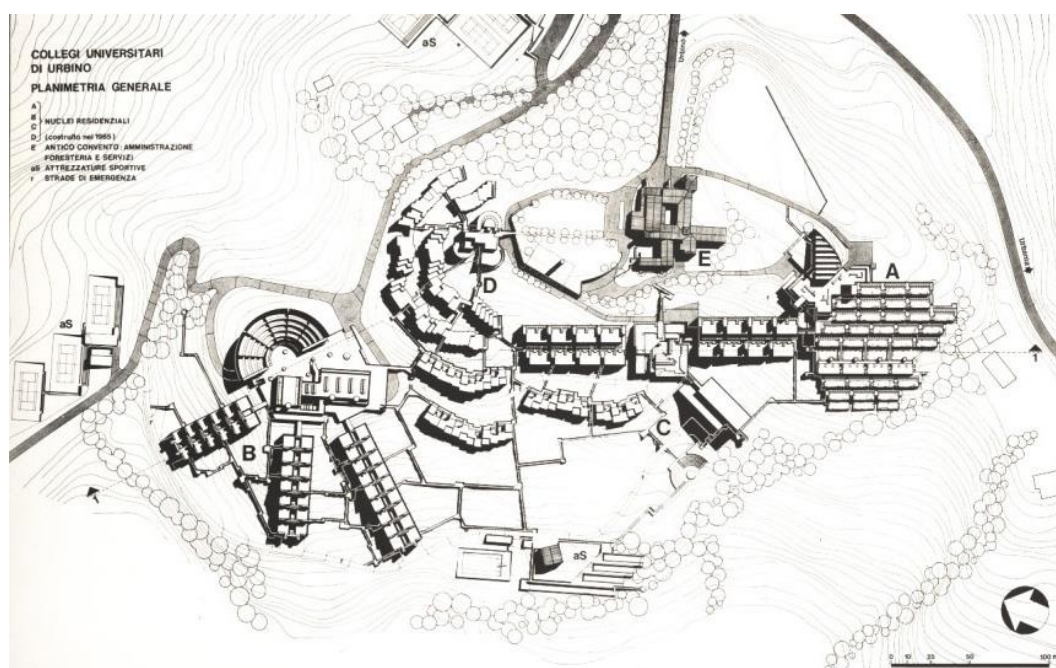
Vista dall'alto dell'intero complesso collegiale - Fonte: www.architettura.it
